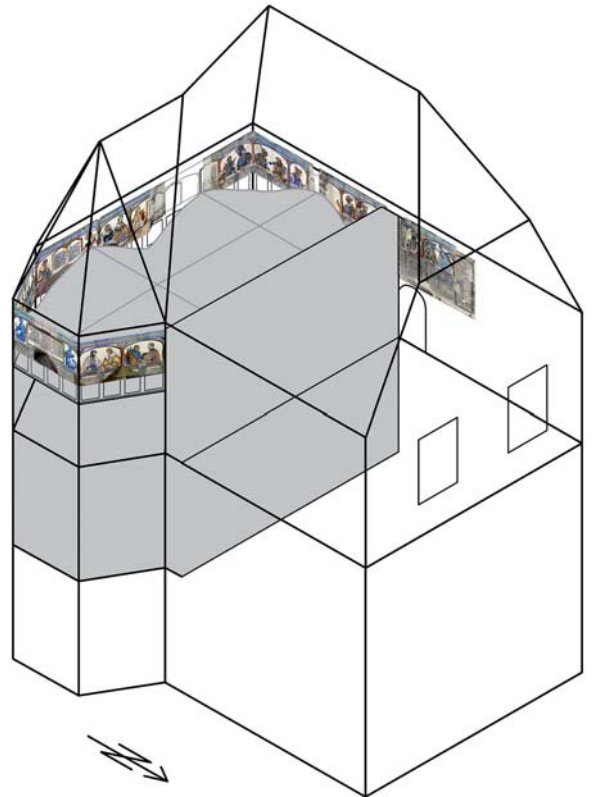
Rekonstruktion des Gebäudes mit eingebauter zweigeschossiger Kapelle (um 1600 bis 1944)
